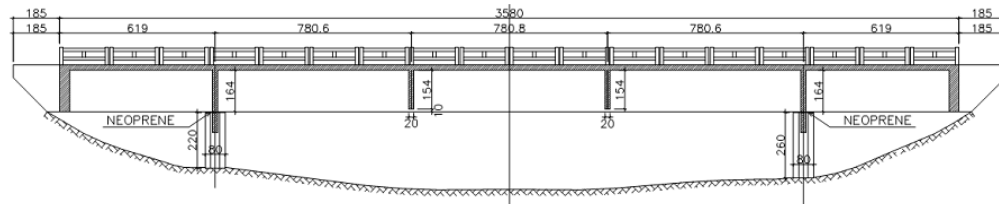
Corte longitudinal na geometria original da ponte 2.
